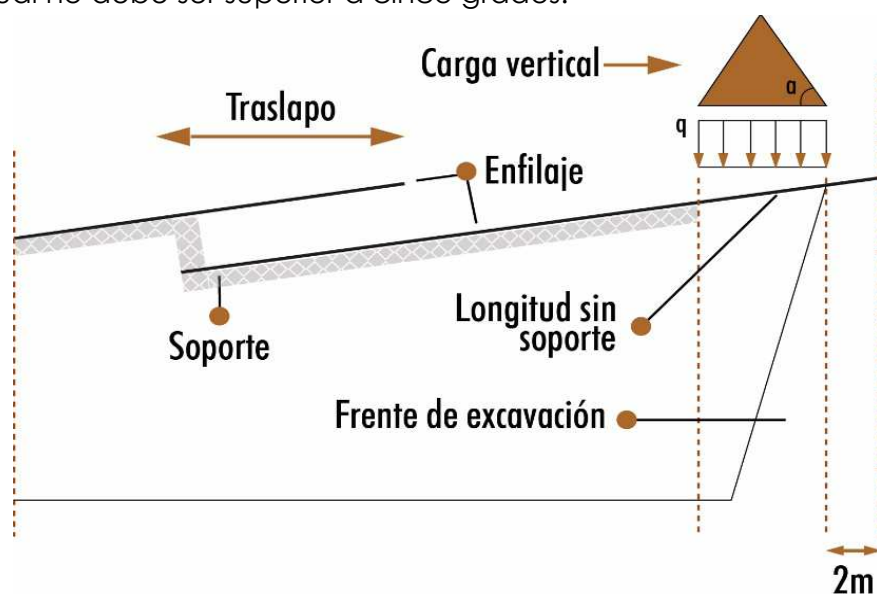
Cálculo de sistema de enfilaje como una viga simplemente apoyada
